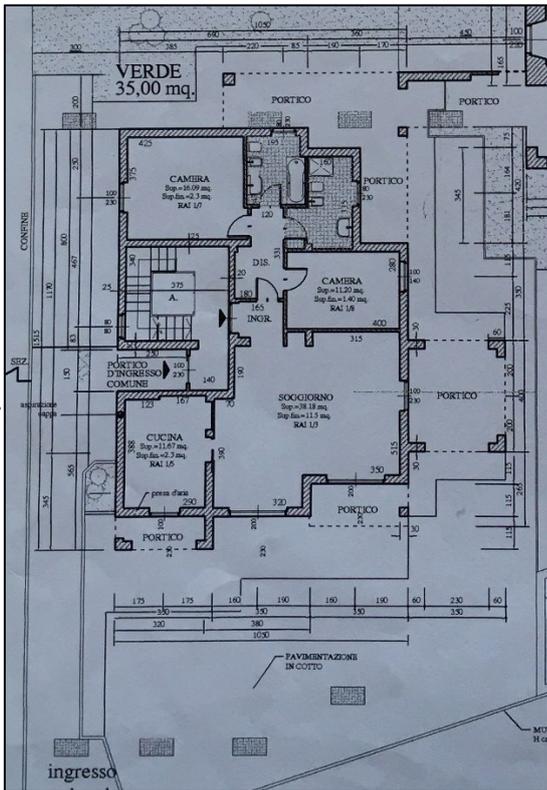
Estratto pianta piano terra dell'edificio tipo (disegno fuori scala)
